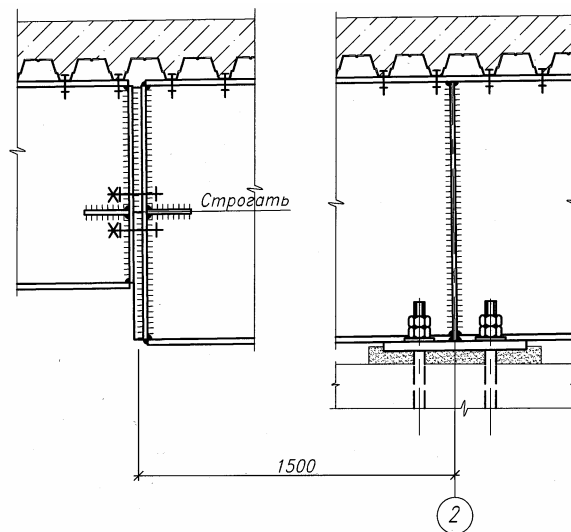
Узлы сопряжения балок друг с другом и фундаментом
